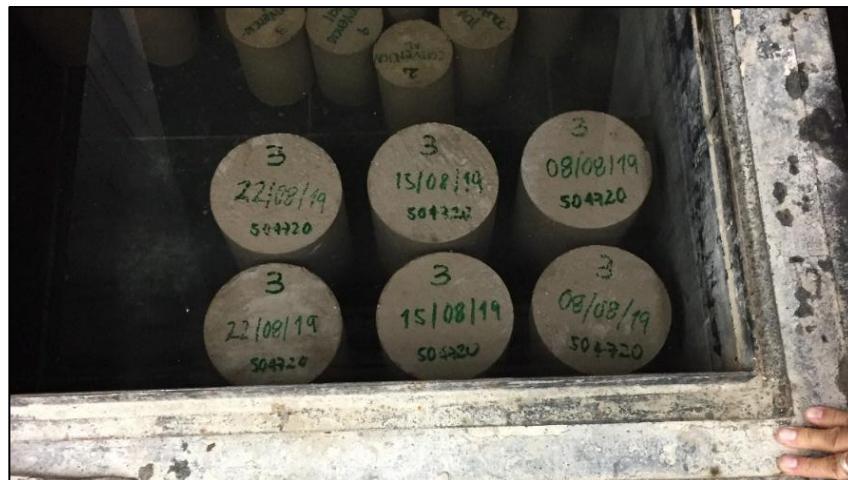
Marcado Cilindros para Fallar a 7-14-28 Días Concreto Reforzado
